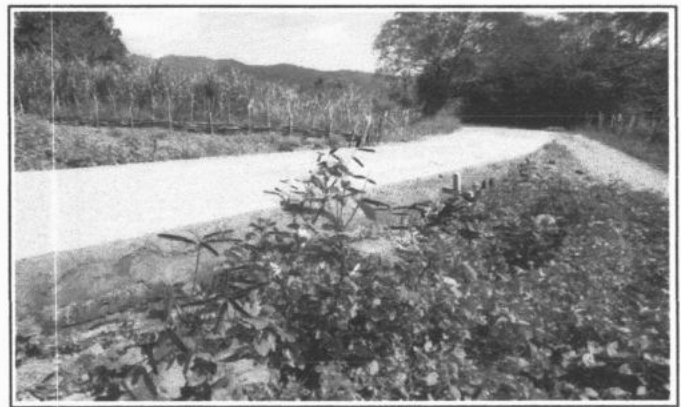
VISTA LATERAL PASSAGEM MOLHADA
